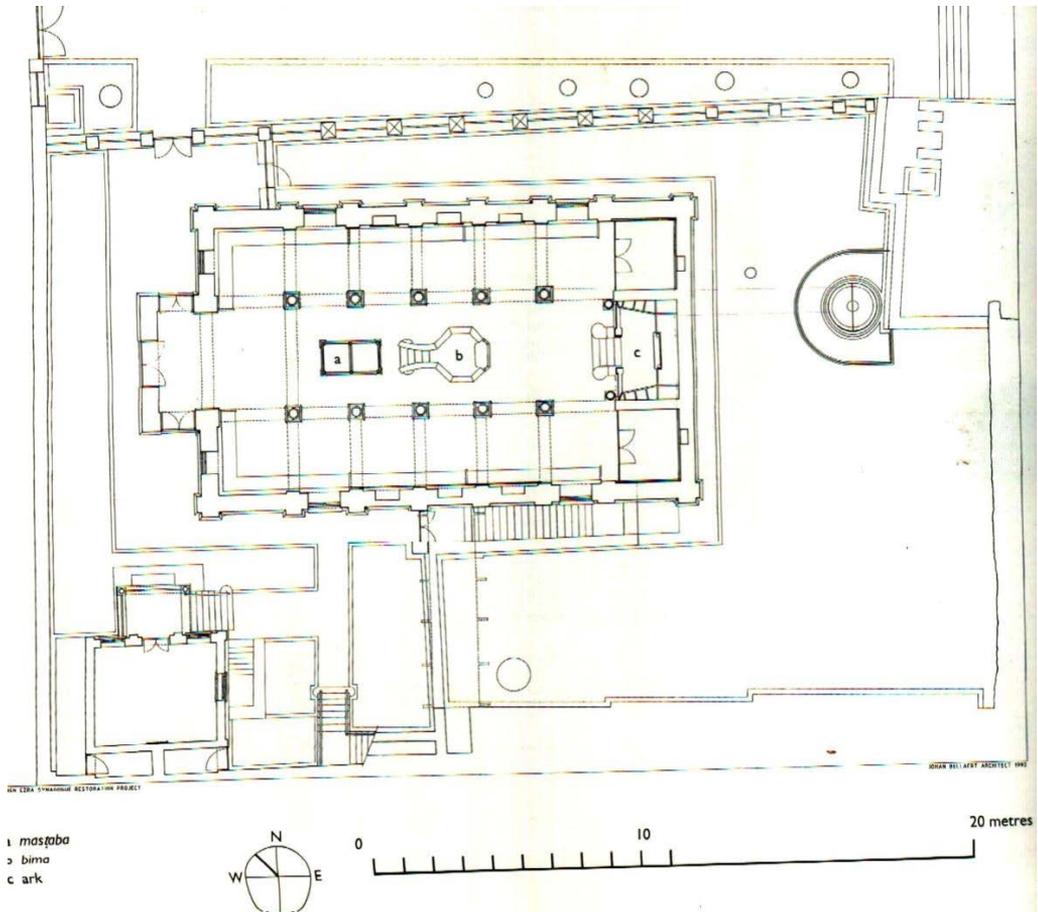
Planta do piso térreo da Sinagoga de Ben Ezá (desenho de Claire Daliers e Brigitte Boitte).
